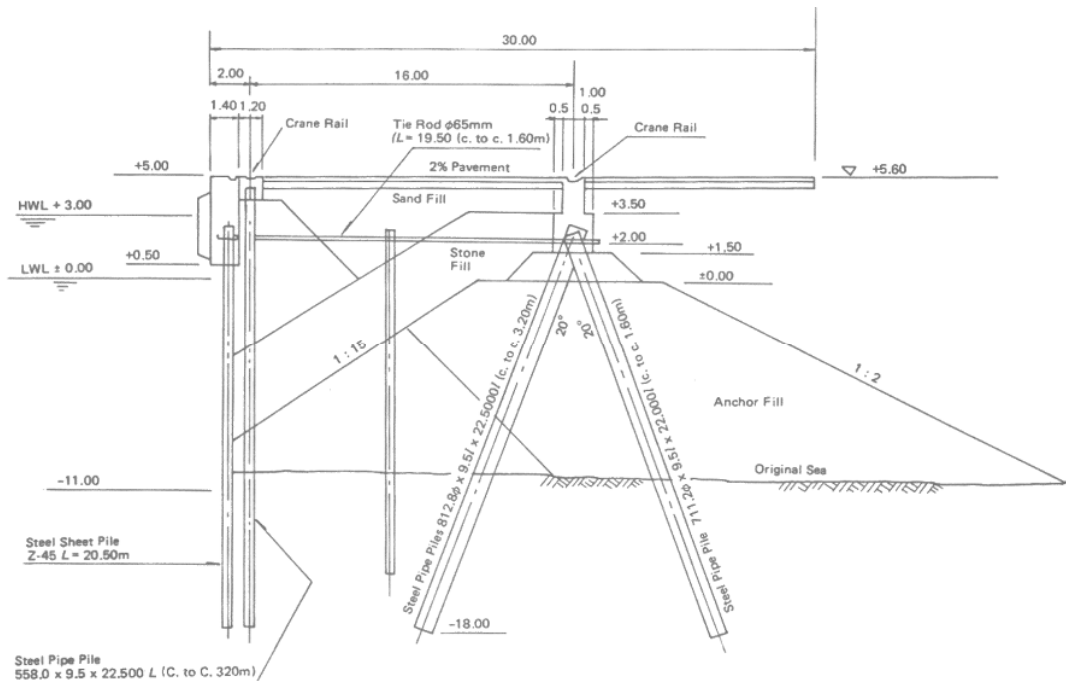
Sección típica puesto No. 1 (Fuente. JICA)
